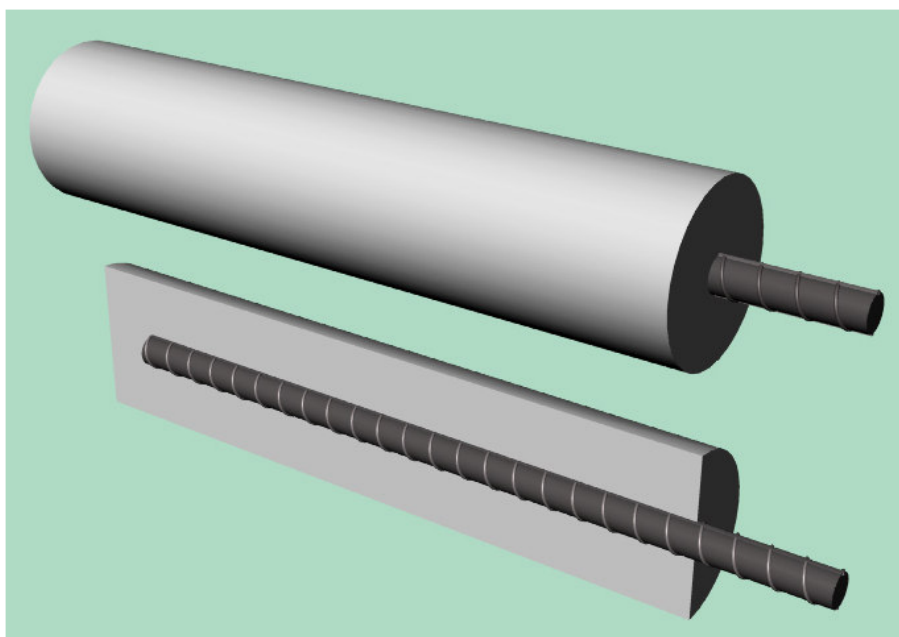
Modelo de corpo-de-prova, aço/concreto, para ensaio de corrosão acelerado.
